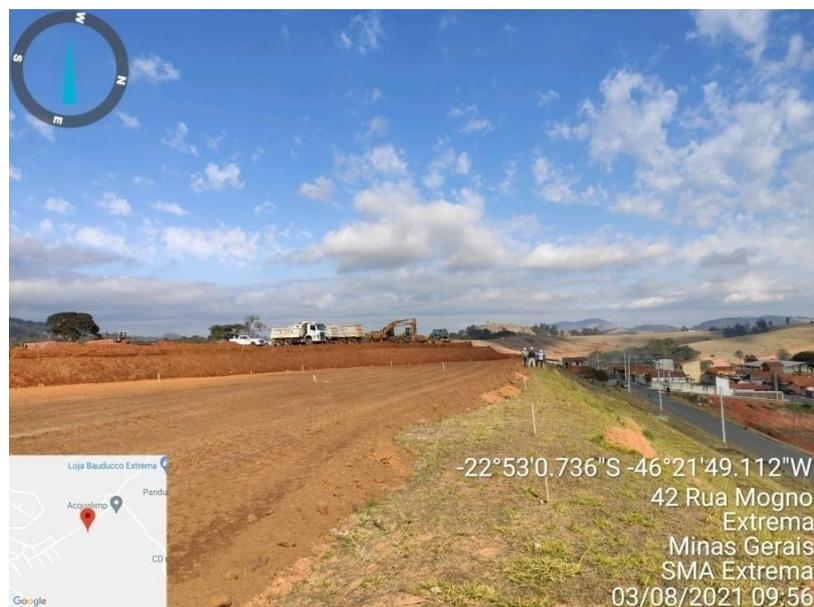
Terraplanagem da área a instalar o Edifício C, com vista parcial para o bairro Mantiqueira.
